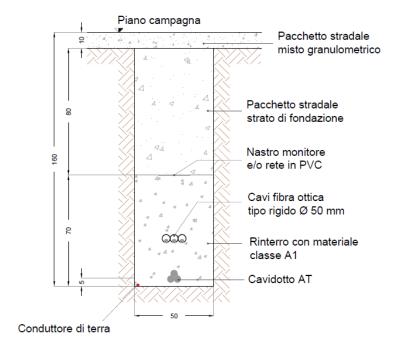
Sezione tipo cavidotto AT una terna su strada sterrata
